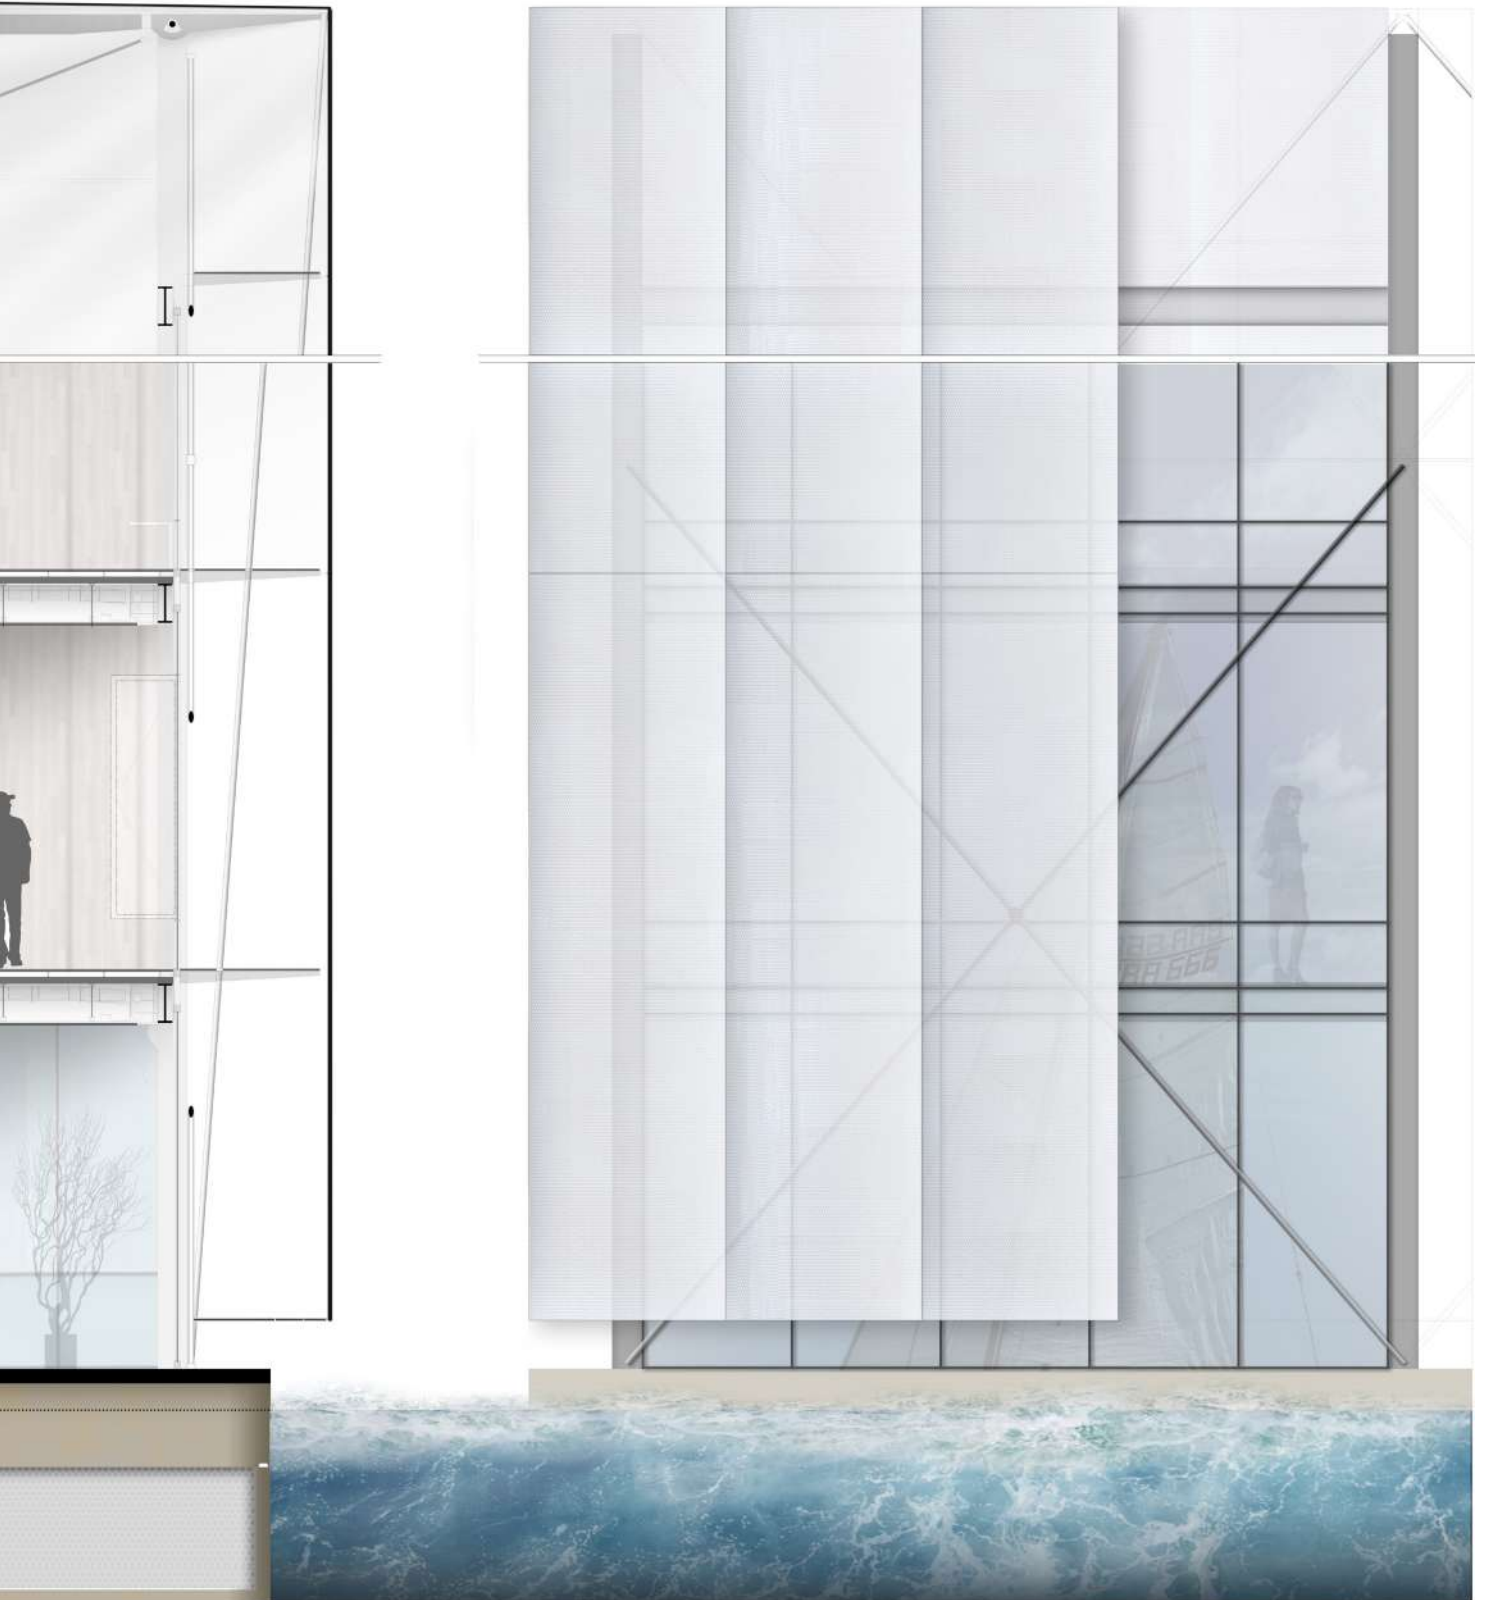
Ampliação de corte e elevação de um pavilhão do museu
